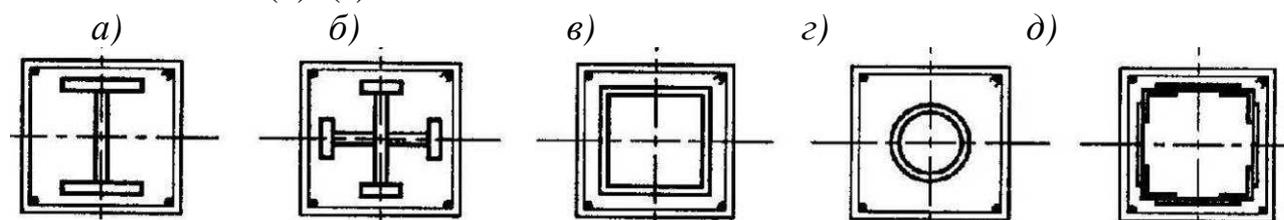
Типы поперечных сечений сталежелезобетонных колонн с жесткой арматурой из различных стальных профилей
